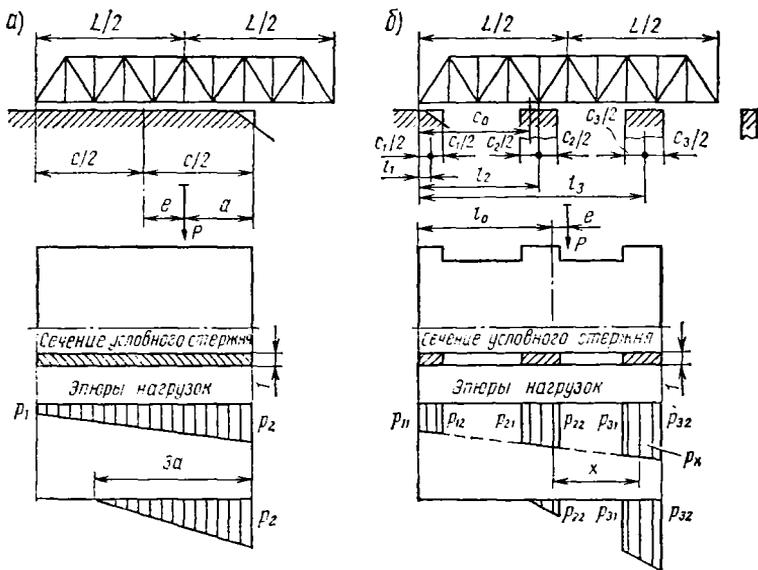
Схемы опирания и эпюры нагрузок от пролетных строений на накаточные пути
